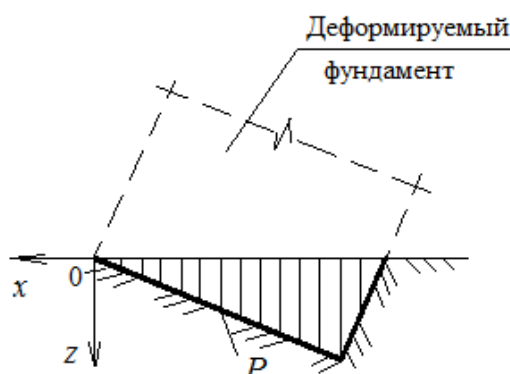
Схема от неравносторонней треугольной нагрузки в основании фундамента
